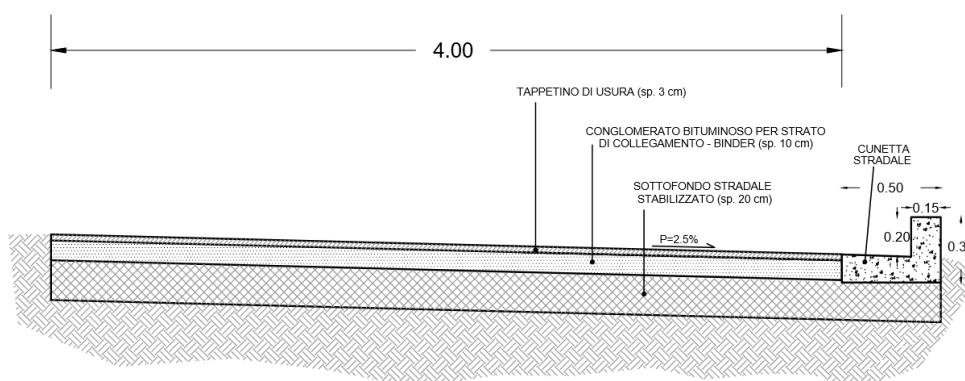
Sistemazione della strada di accesso all'impianto da Via della Scafa.
